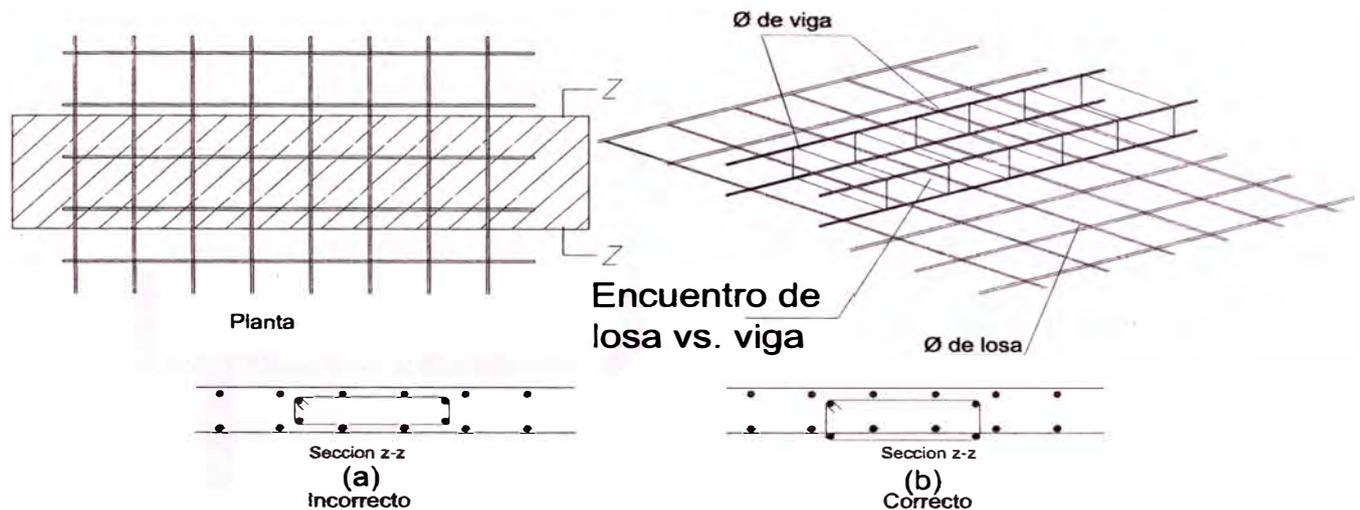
Detalle del encuentro del acero inferior de la losa con la viga chata. Nótese en la perspectiva que el \emptyset inferior reposa sobre el \emptyset positivo de la viga. Esto garantiza un acople superior al que ocurriría con toda la viga entre ambos refuerzos de la losa.
